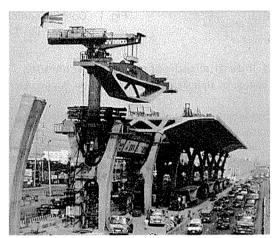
D6 segment with underslung girder 図 - 3 D6 セグメントおよび下弦式架設桁
